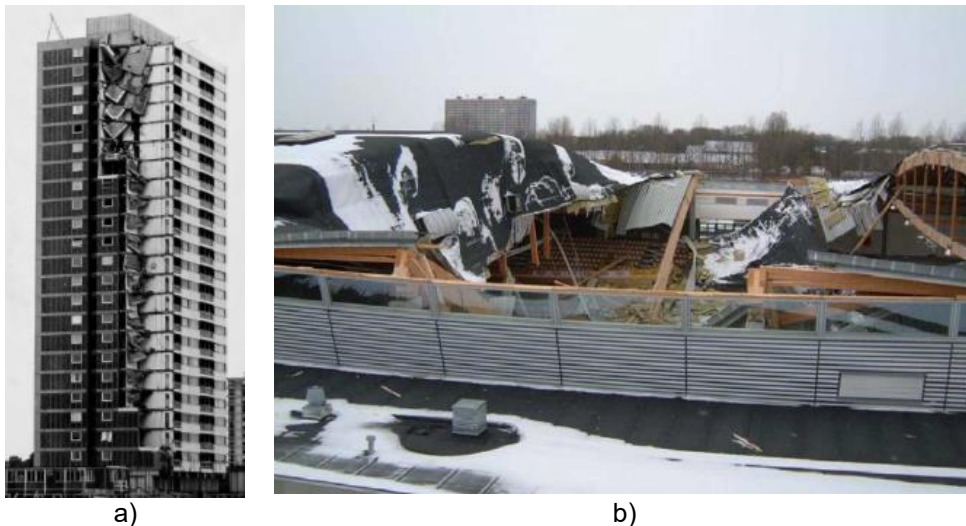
Colapso a) parcial do Ronan Point Building e b) total da arena Siemens.
